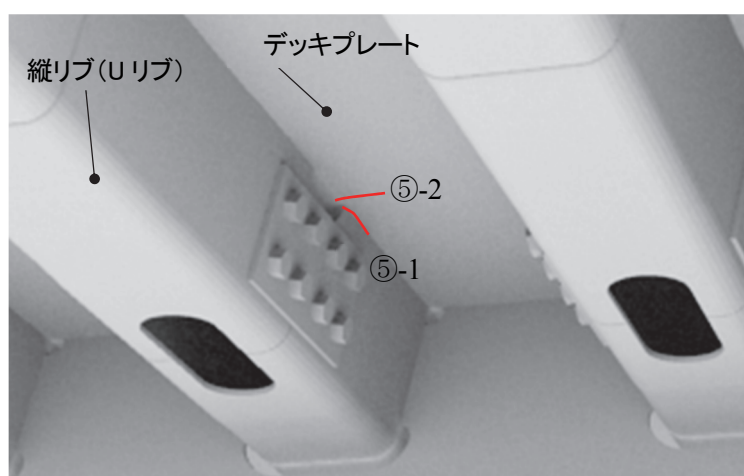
縦リブ(Uリブ)現場継ぎ手スカラップ部の溶接部の損傷タイプ
